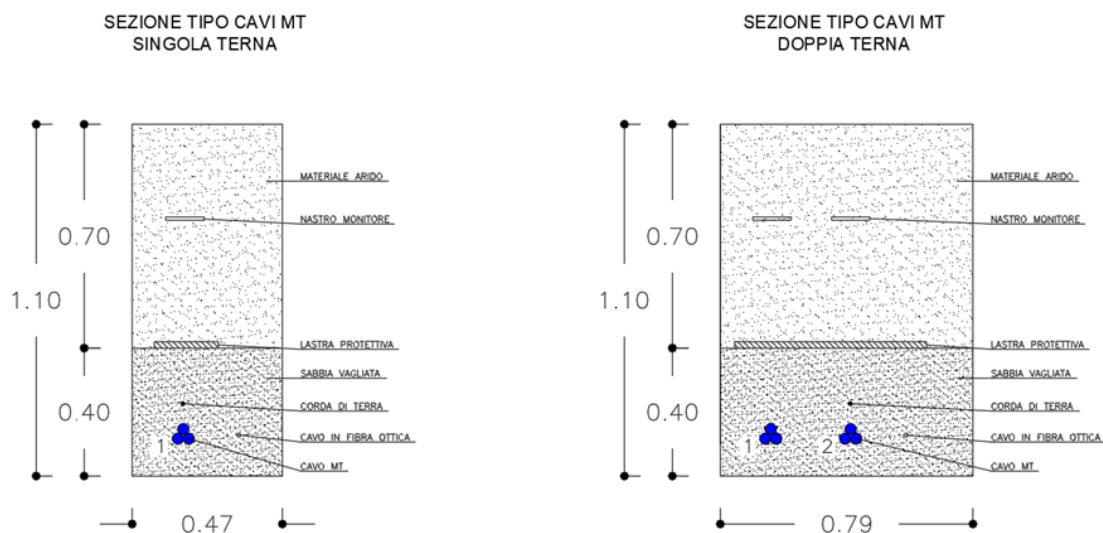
Sezione tipo scavi MT (singola terna e doppia terna)
